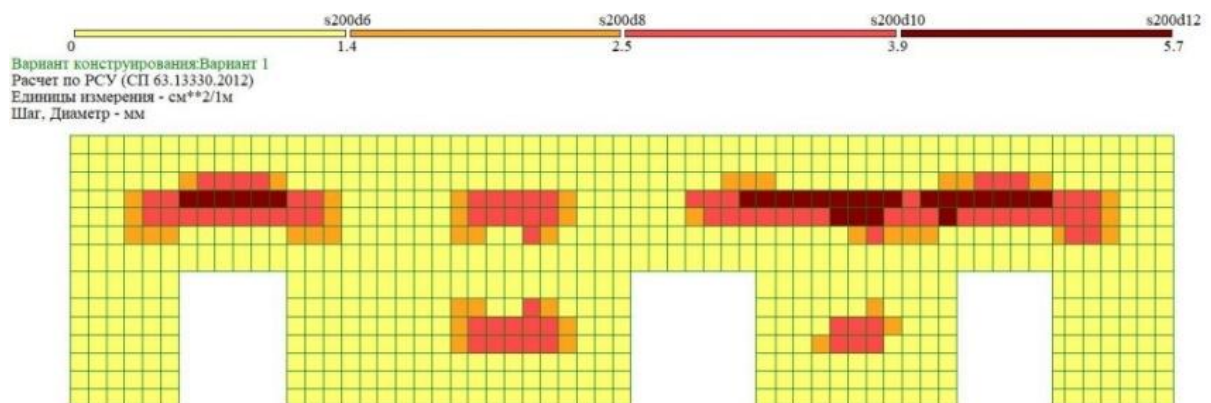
Подбор нижней поперечной арматуры плиты
